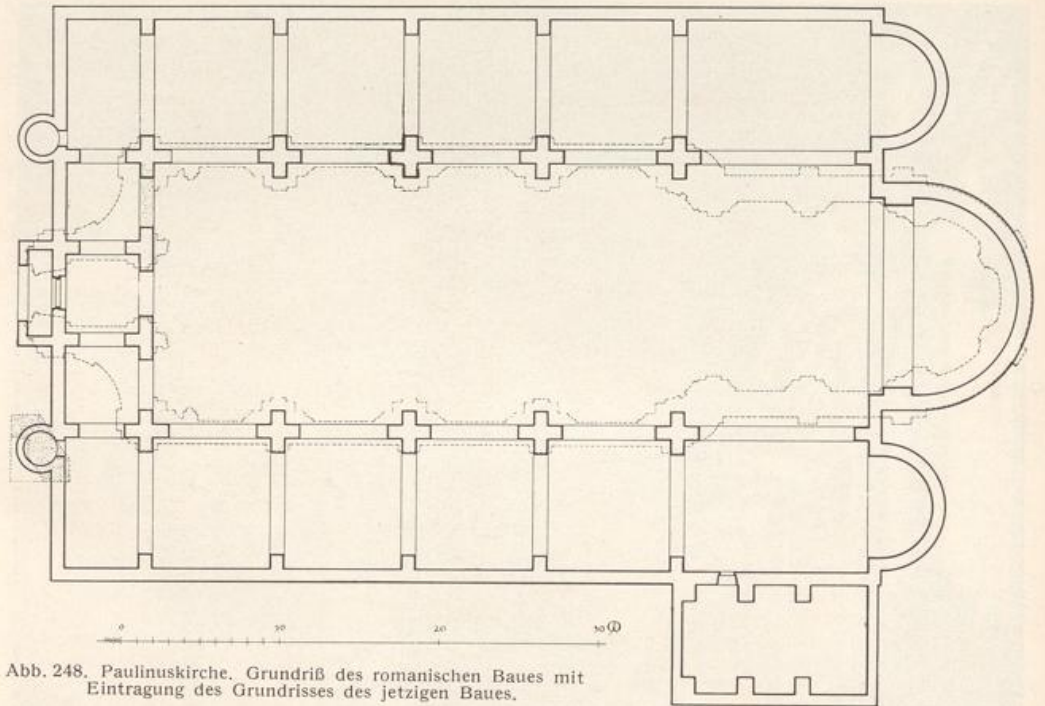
Paulinuskirche. Grundriß des romanischen Baues mit Eintragung des Grundrisses des jetzigen Baues.
